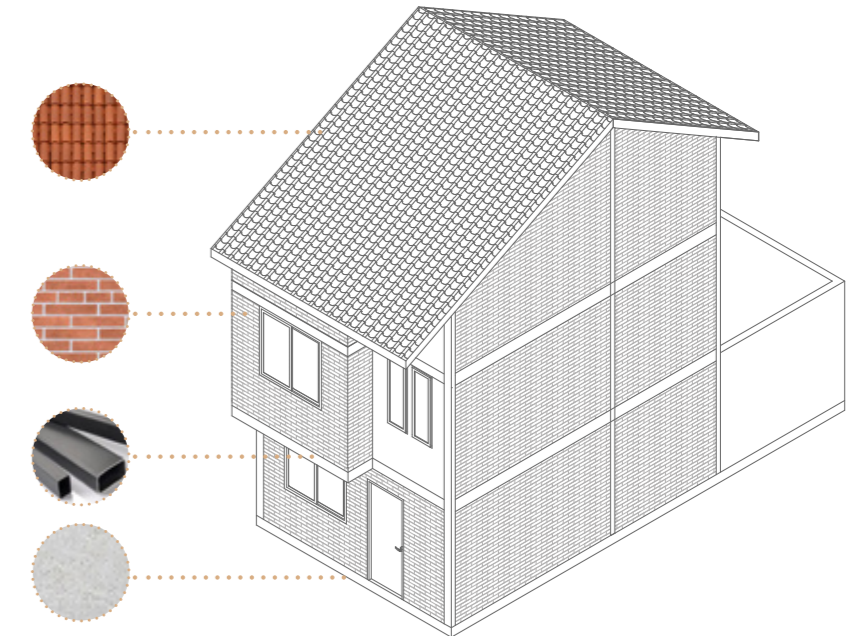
Elementos Constructivos, Los Capulíes. Fuente: Autores, 2023
